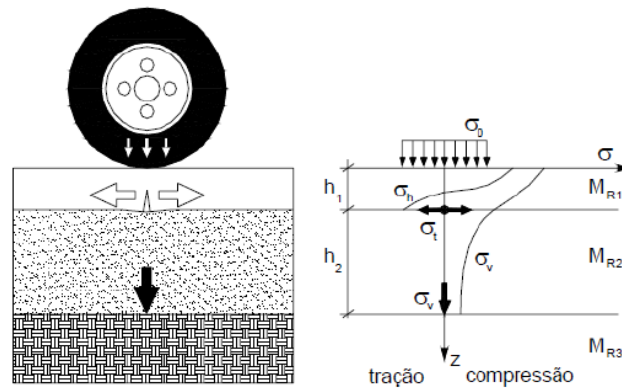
Tensões no interior de um pavimento (MEDINA e MOTTA, 2005)
